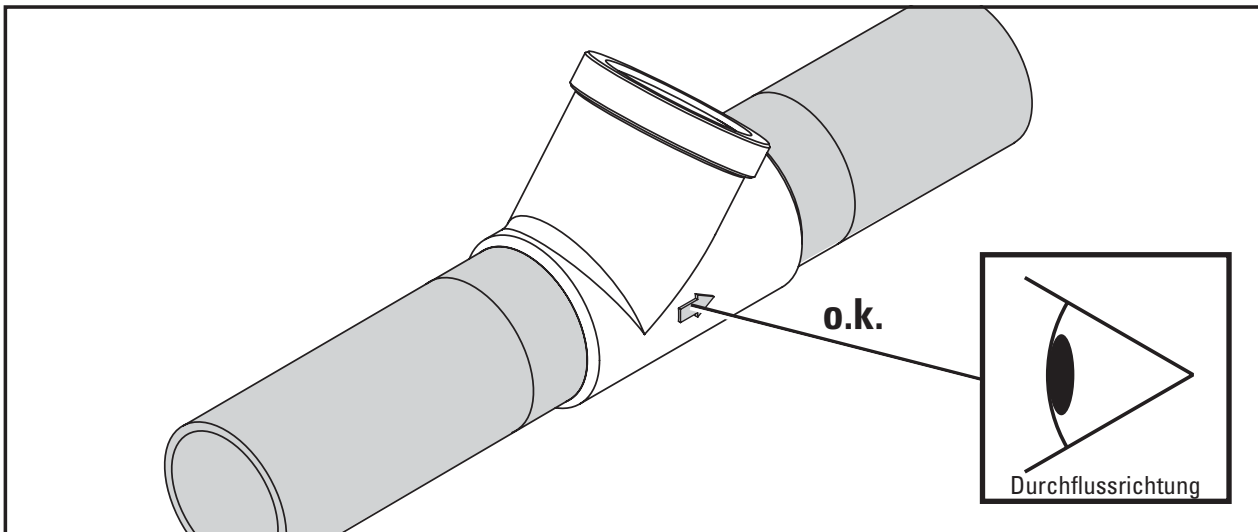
Anschweißen des Ventilgehäuses
